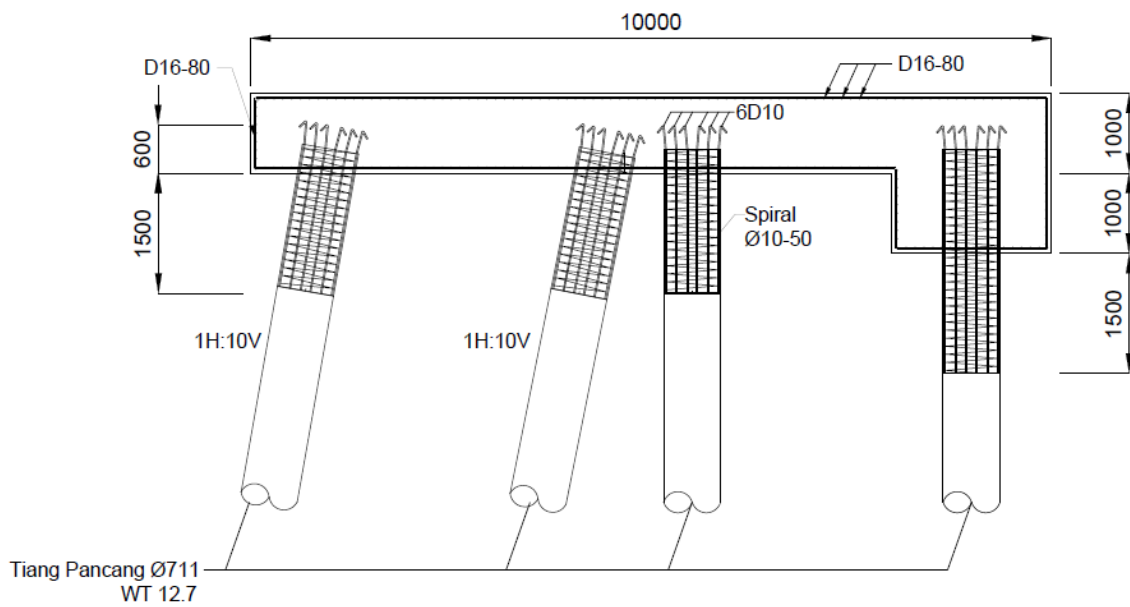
Gambar Potongan Pile Cap Loading Platform
